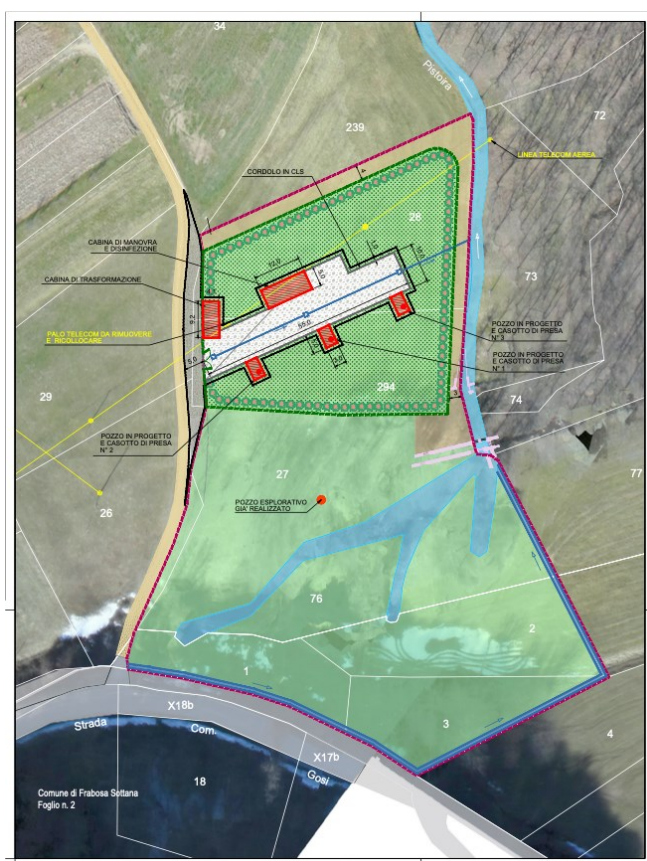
Estratto della planimetria di progetto delle opere di captazione
